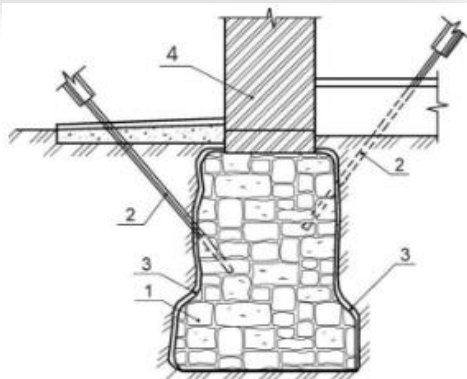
Восстановление несущей способности ленточных фундаментов путем закрепления бутовой кладки цементацией: 1 – усиливаемый фундамент; 2 – иньекторы для нагнетания подвижного (жидкого) цементного раствора; 3 – наплывы раствора; 4 – кирпичная стена
